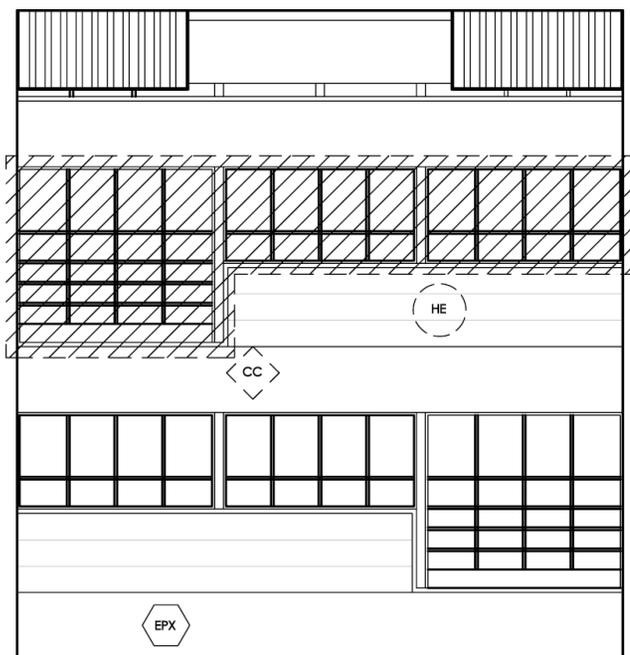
Identificación de deterioros en la fachada oriente. (Fotografía: Guadalupe Cebada, 2017).
